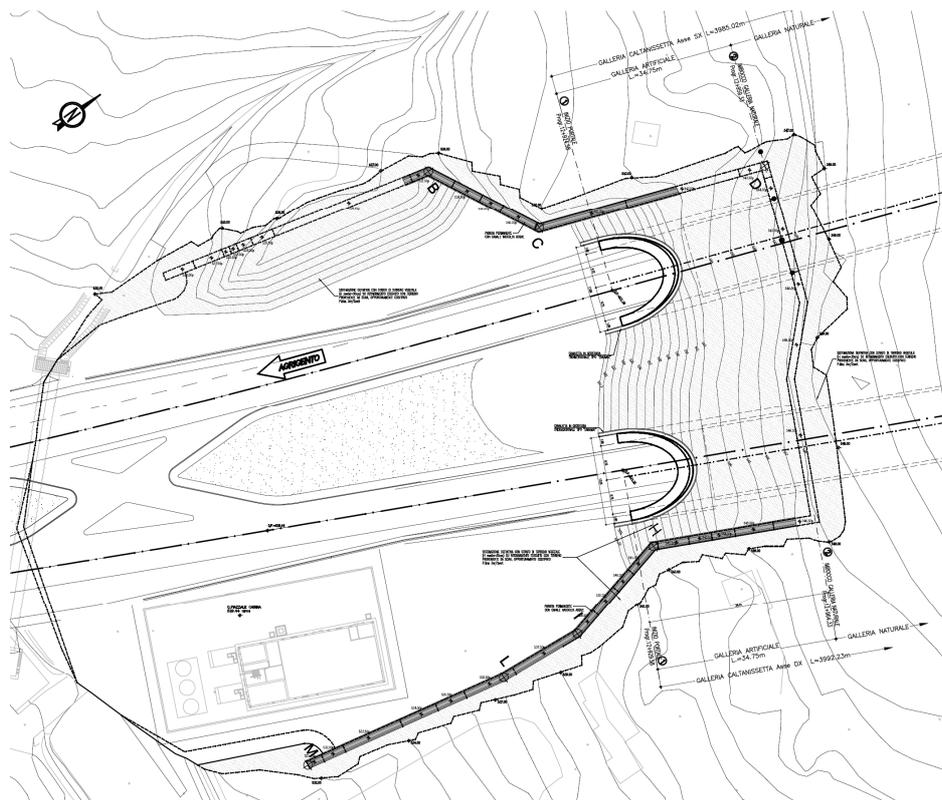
Galleria Caltanissetta – planimetria dell'imbocco lato Agrigento – sistemazione finale
